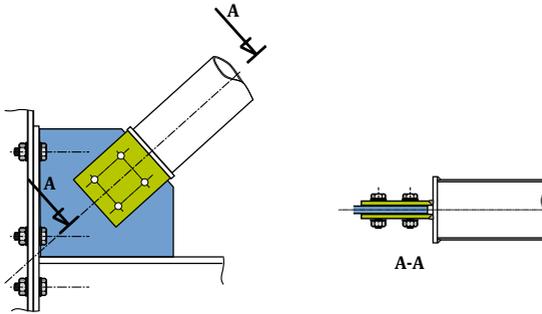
Assemblage par double plat soudé sur platine d'about pour une diagonale à section creuse circulaire
